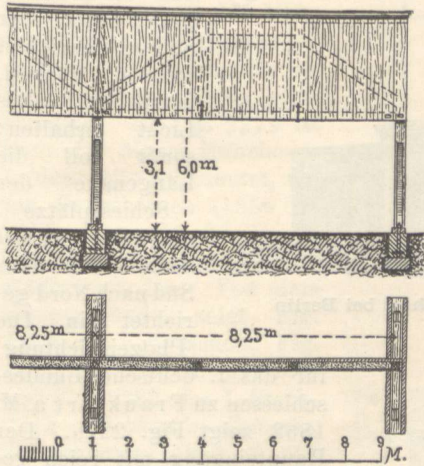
Grundriss und Ansicht der Blende.
